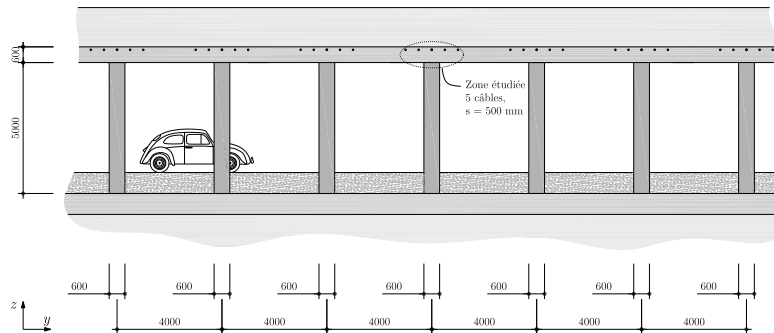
Coupe longitudinale d'une tranchée couverte - Mise en évidence de la zone étudiée sujette au risque de poinçonnement - Données en [mm]
